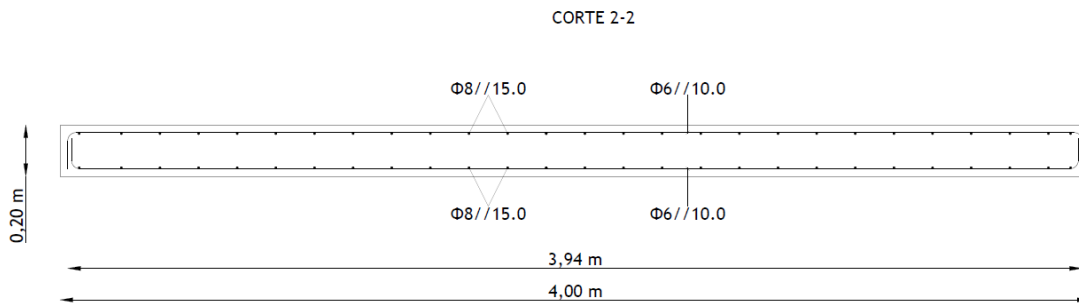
Pormenorização de armaduras relativas ao corte longitudinal à cota 2,0 metros.
